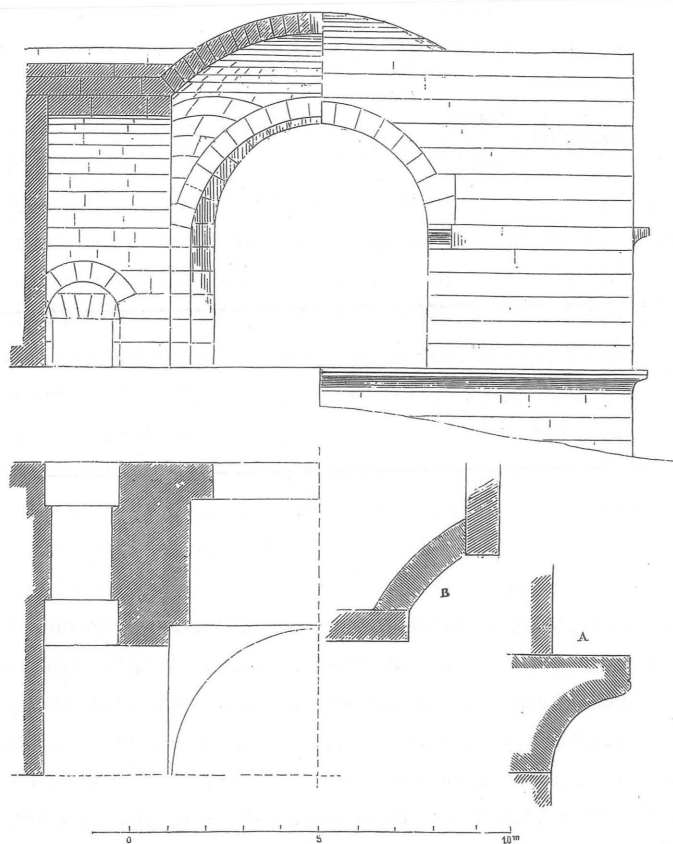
Bóveda esférica con pechinas sobre planta cuadrada (ruinas de Gerasa)
